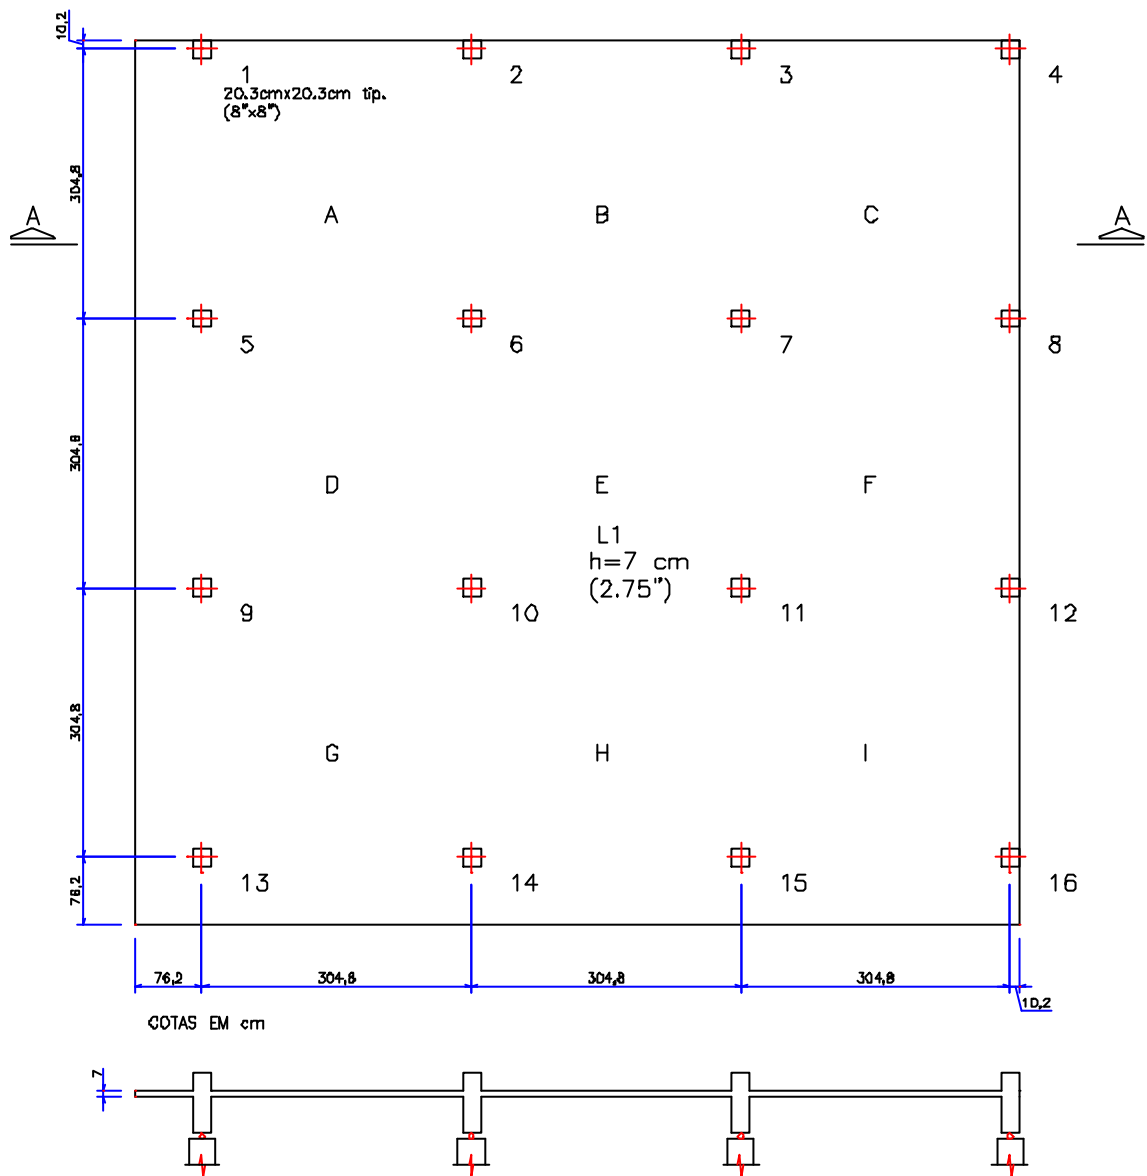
Planta e Elevação da Laje II – 1975
